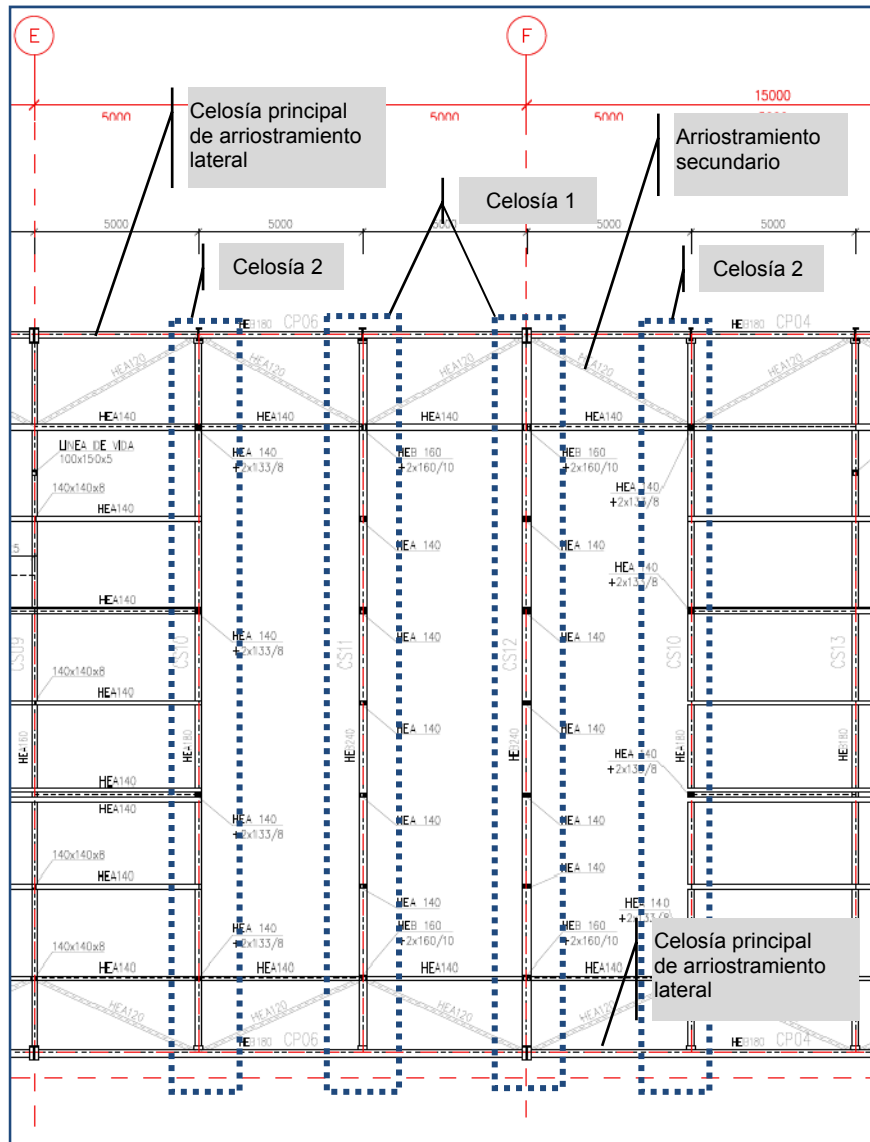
Planta Superior de Cubierta. Celosía 1 y 2
